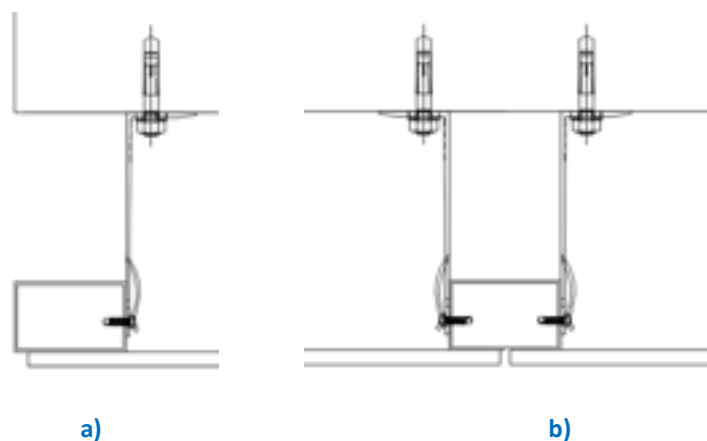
Disegno esecutivo facciata della parete nord: dettaglio collegamento al bordo (a) e fra due lastre (b)
